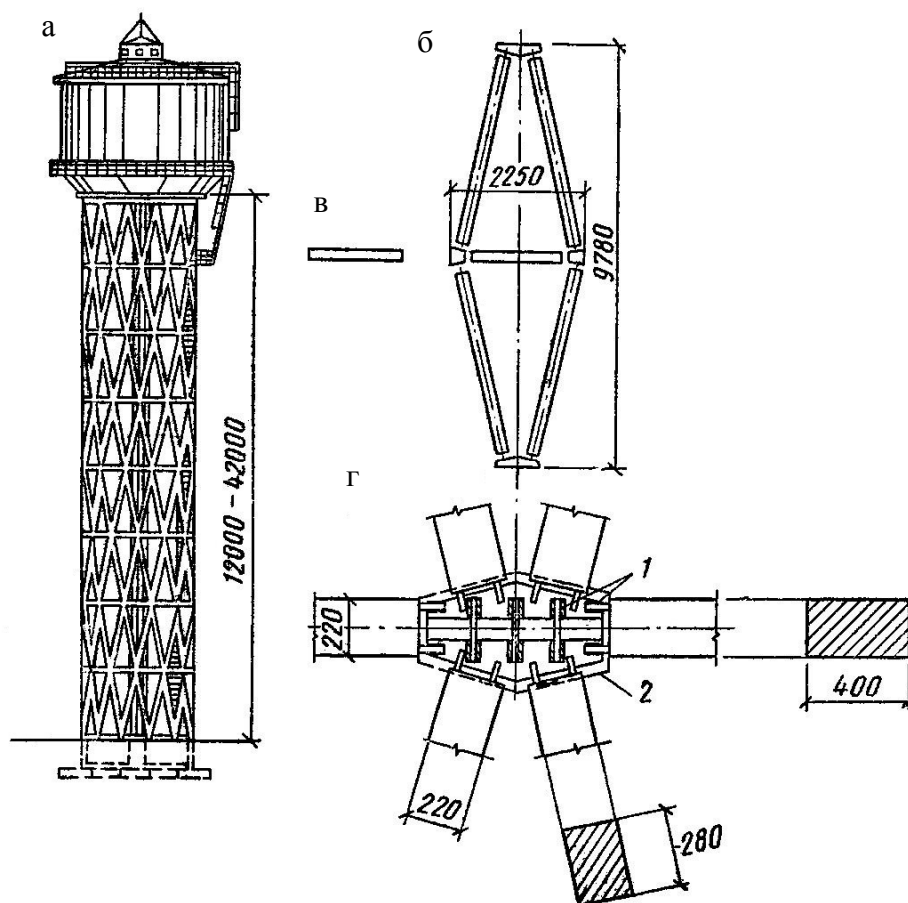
Водонапорная башня с опорой пространственной сетчатой конструкции: а – общий вид башни; б – ромбическая панель; в – поясной элемент; г – узел сопряжения сборных элементов; 1 – монтажная сварка; 2 – граница бетона замоноличивания
